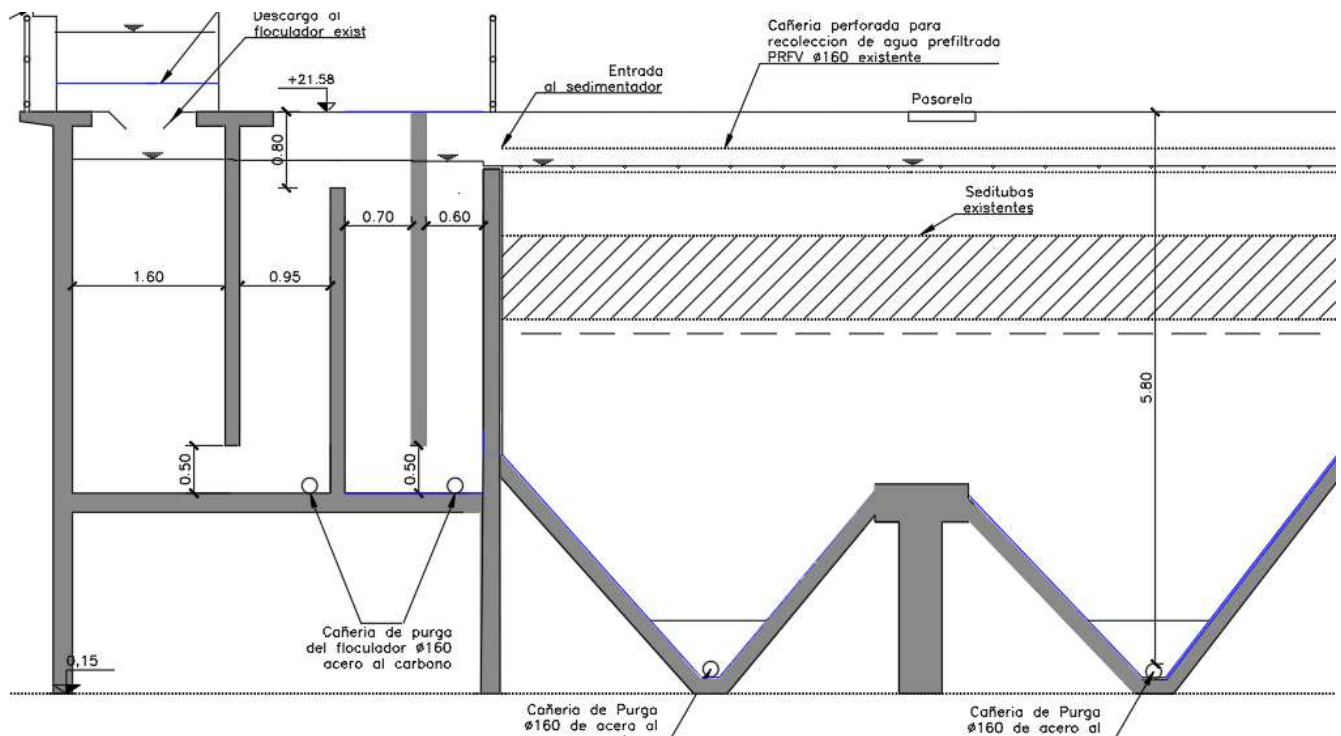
Cañerías de descarga del floculador y los sedimentadores – Fuente de elaboración propia
